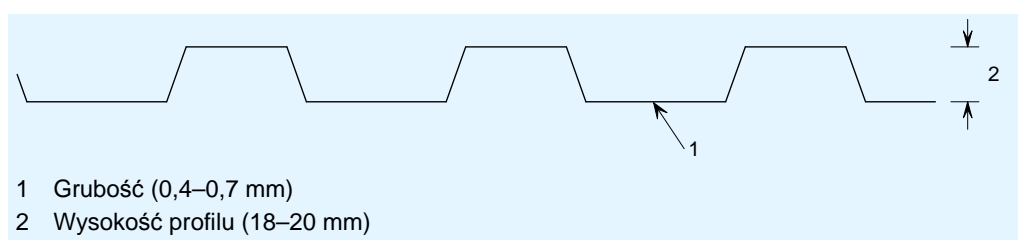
Wielowarstwowa okładzina dachowa
